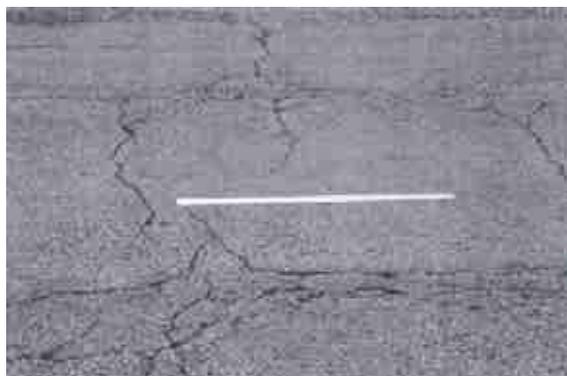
Falla Fisuramiento en Bloque – Severidad Baja
